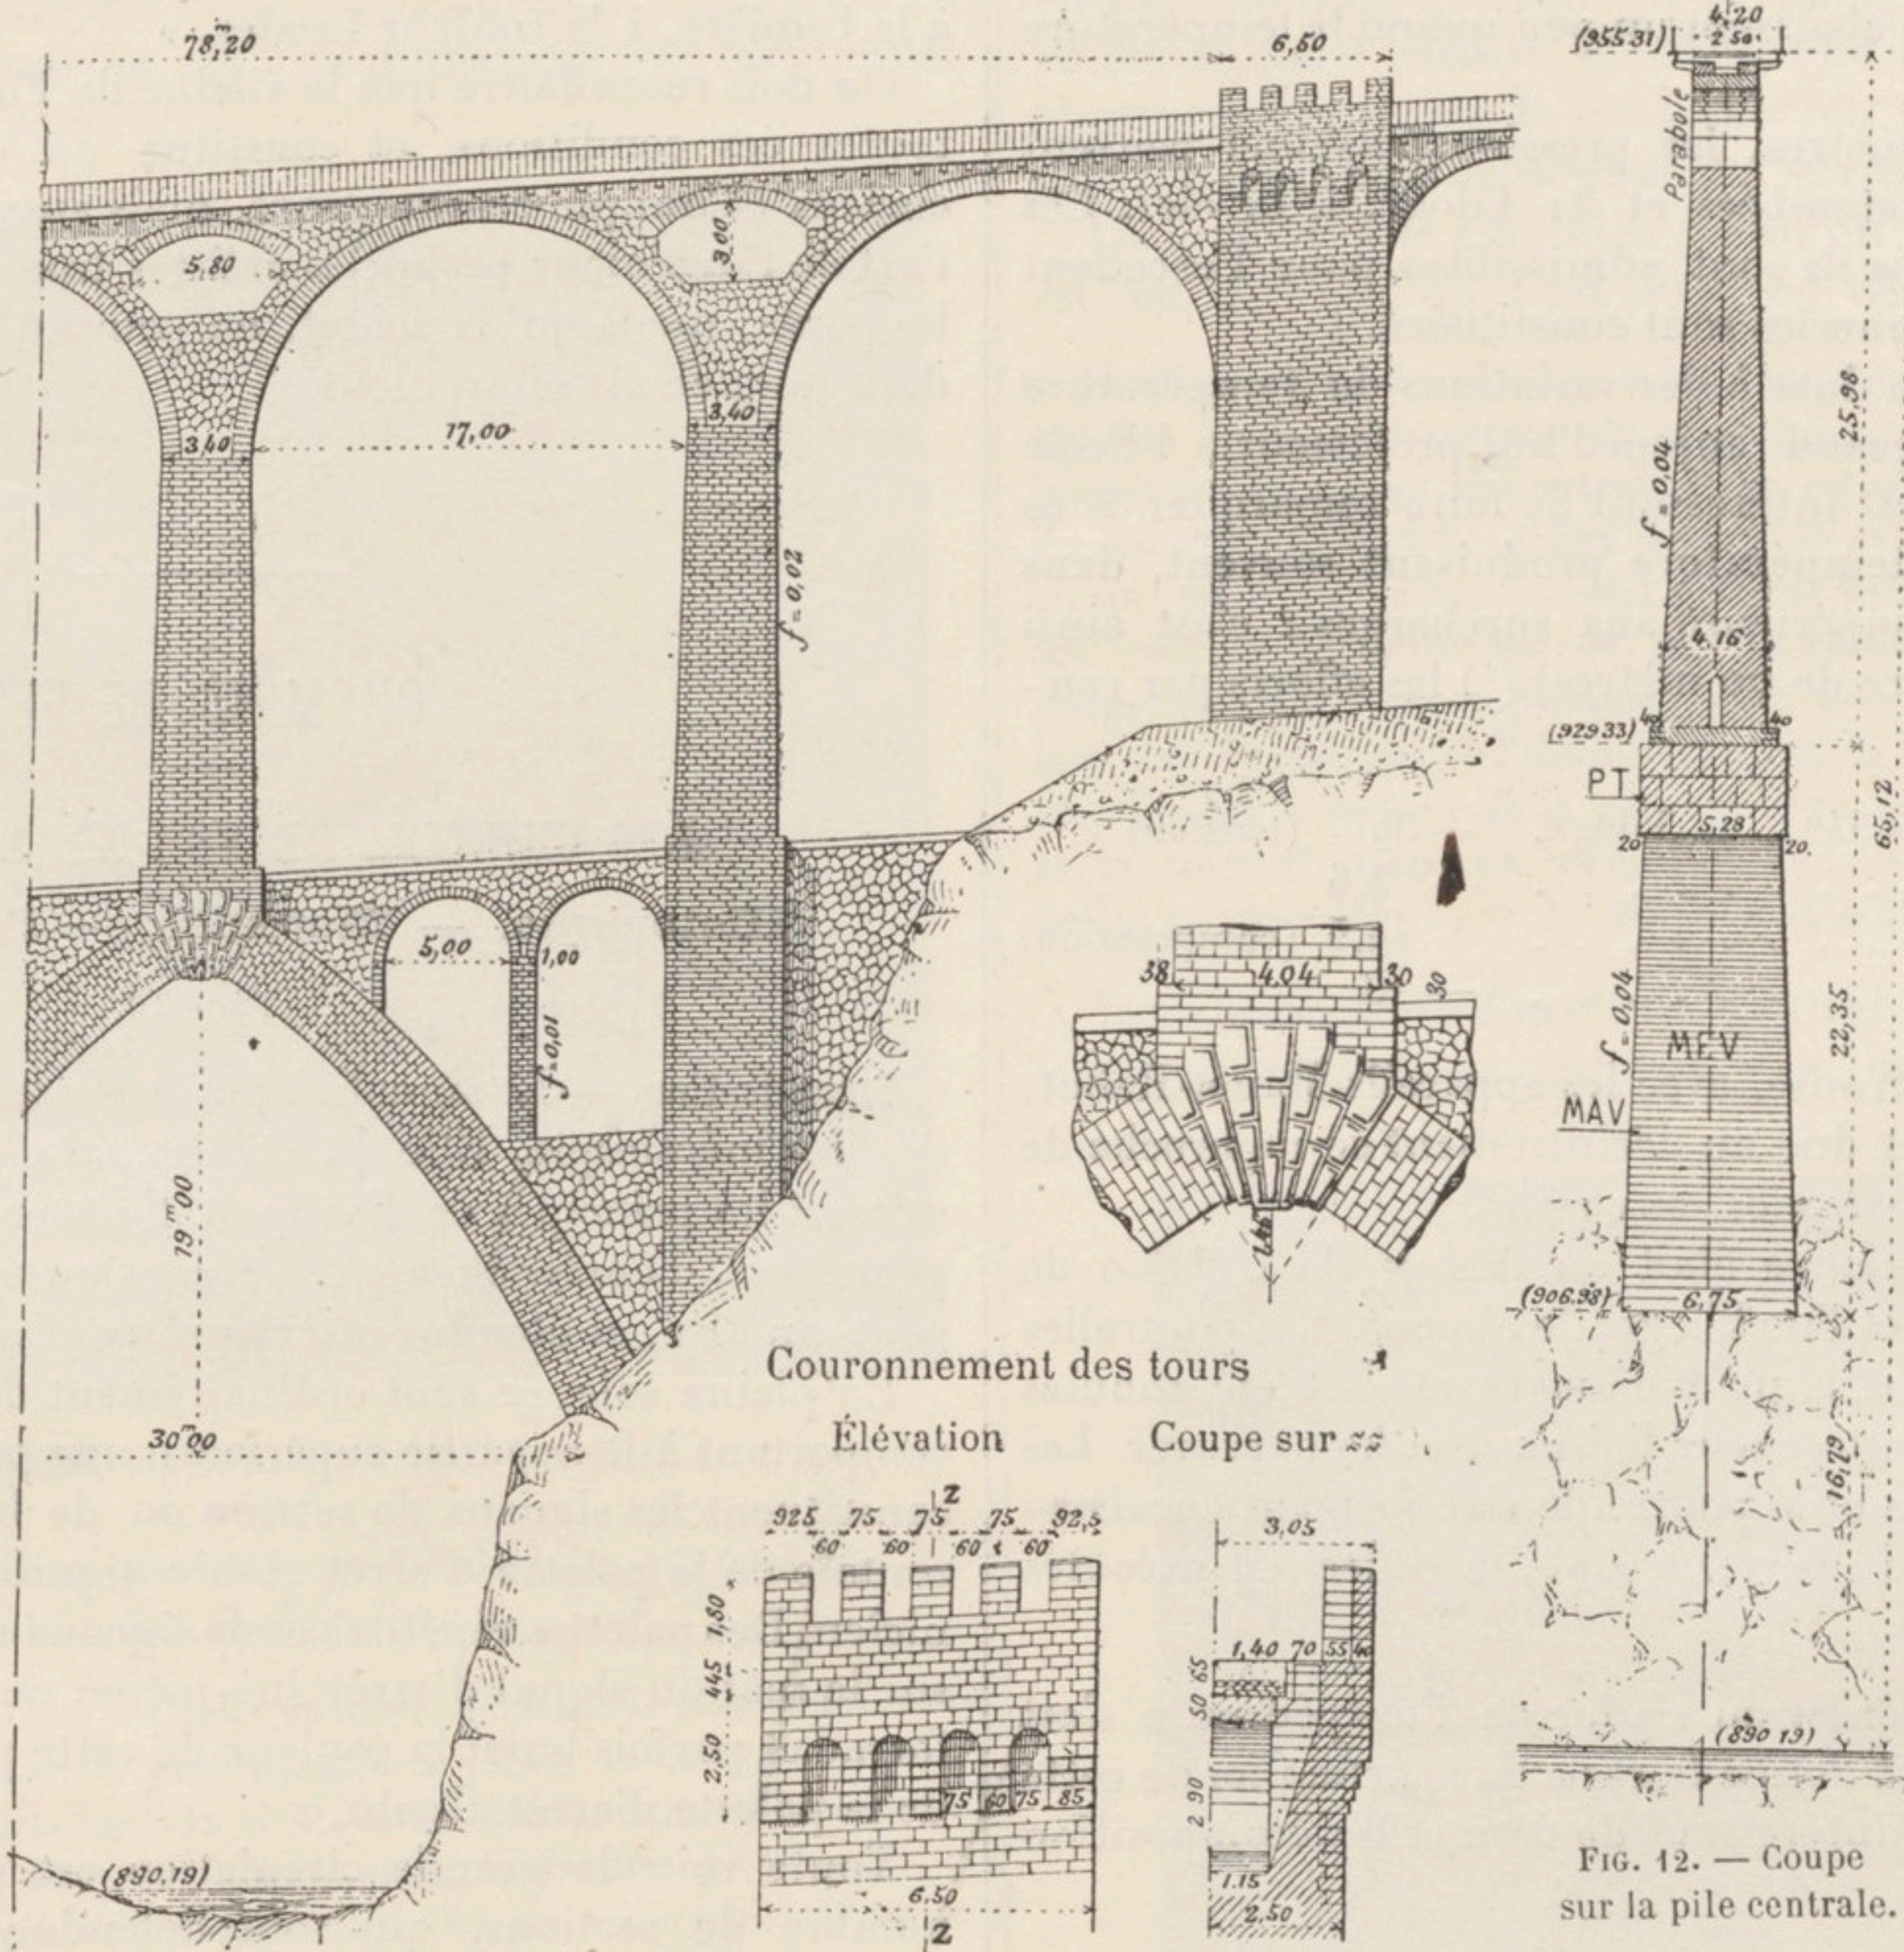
à 15. — Élévation partielle, coupe sur la pile centrale et détails.
